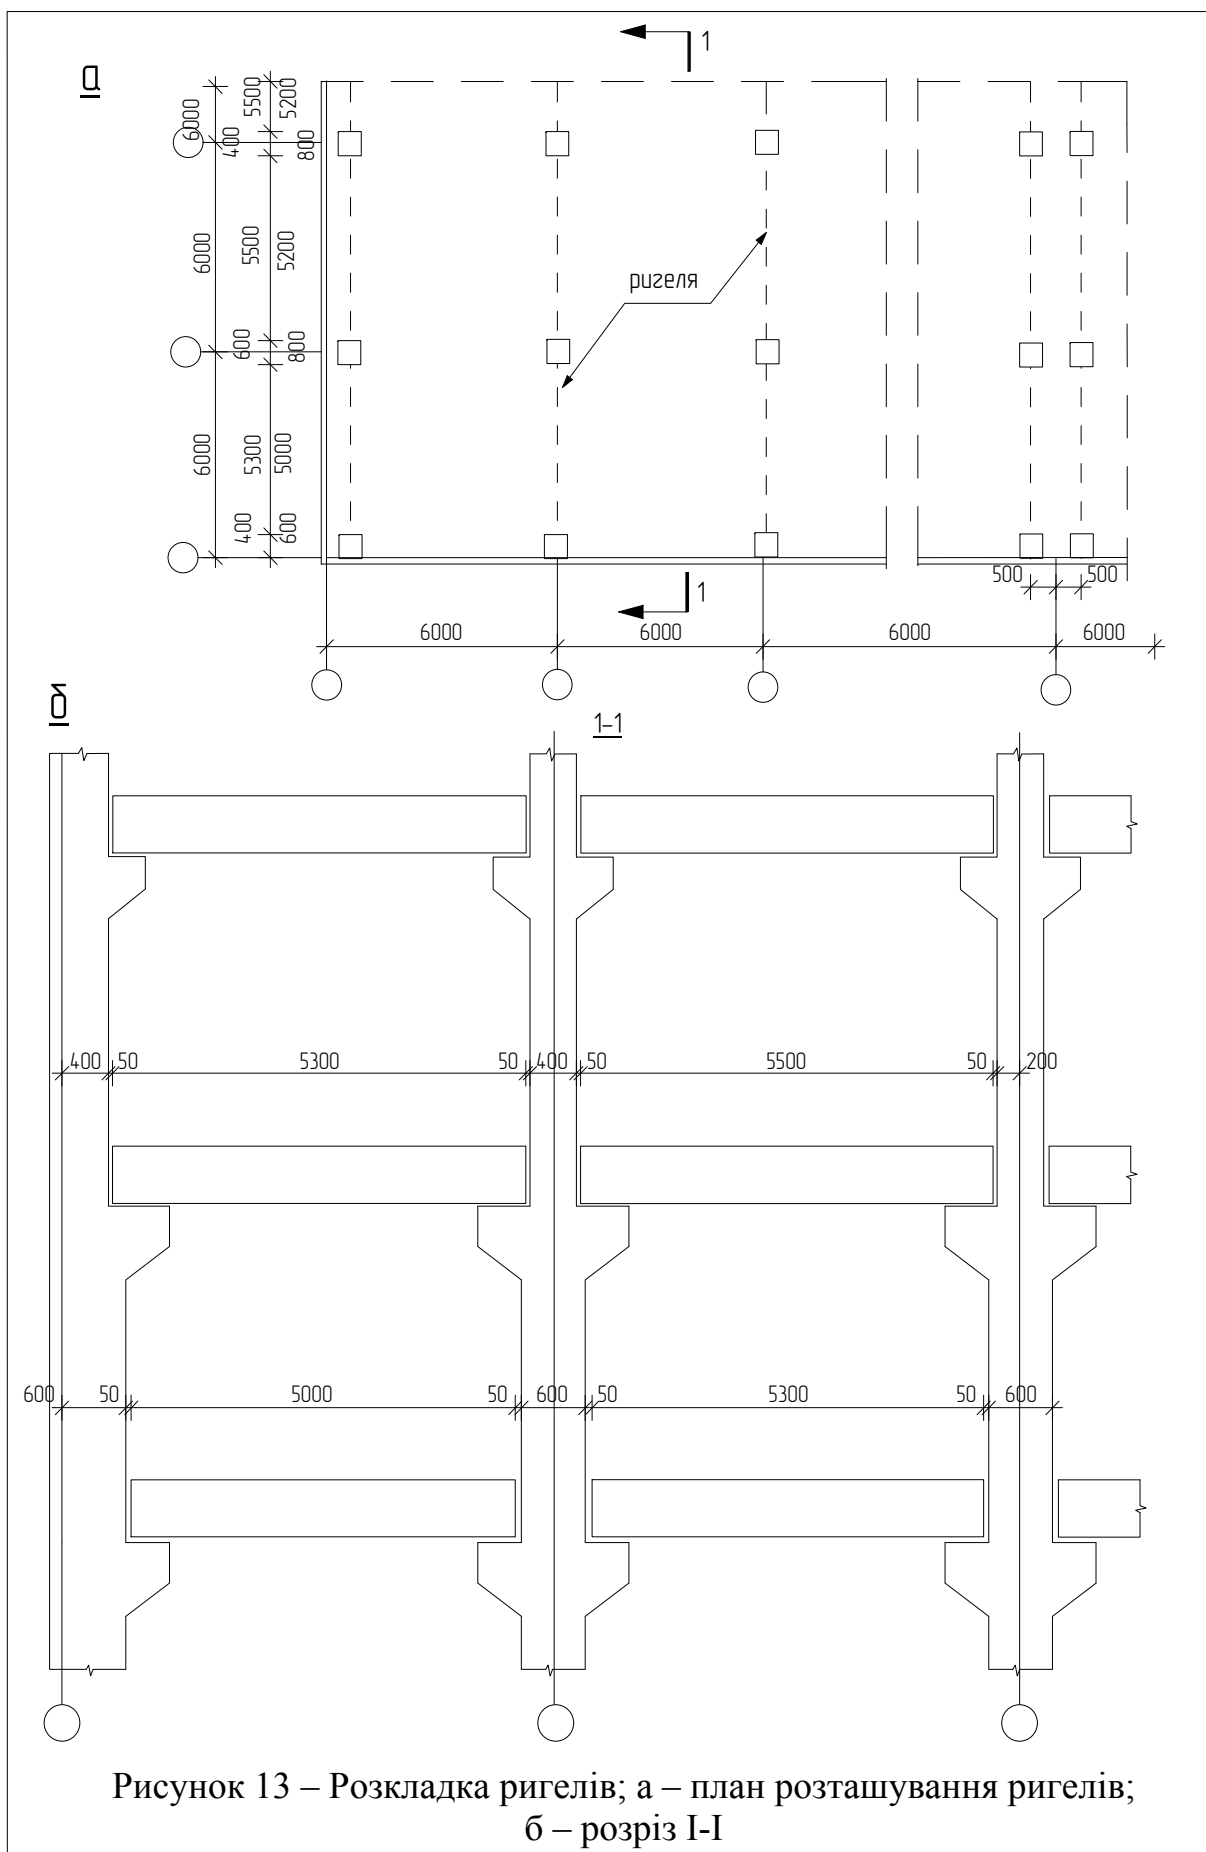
Розкладка ригелів; а – план розташування ригелів;
